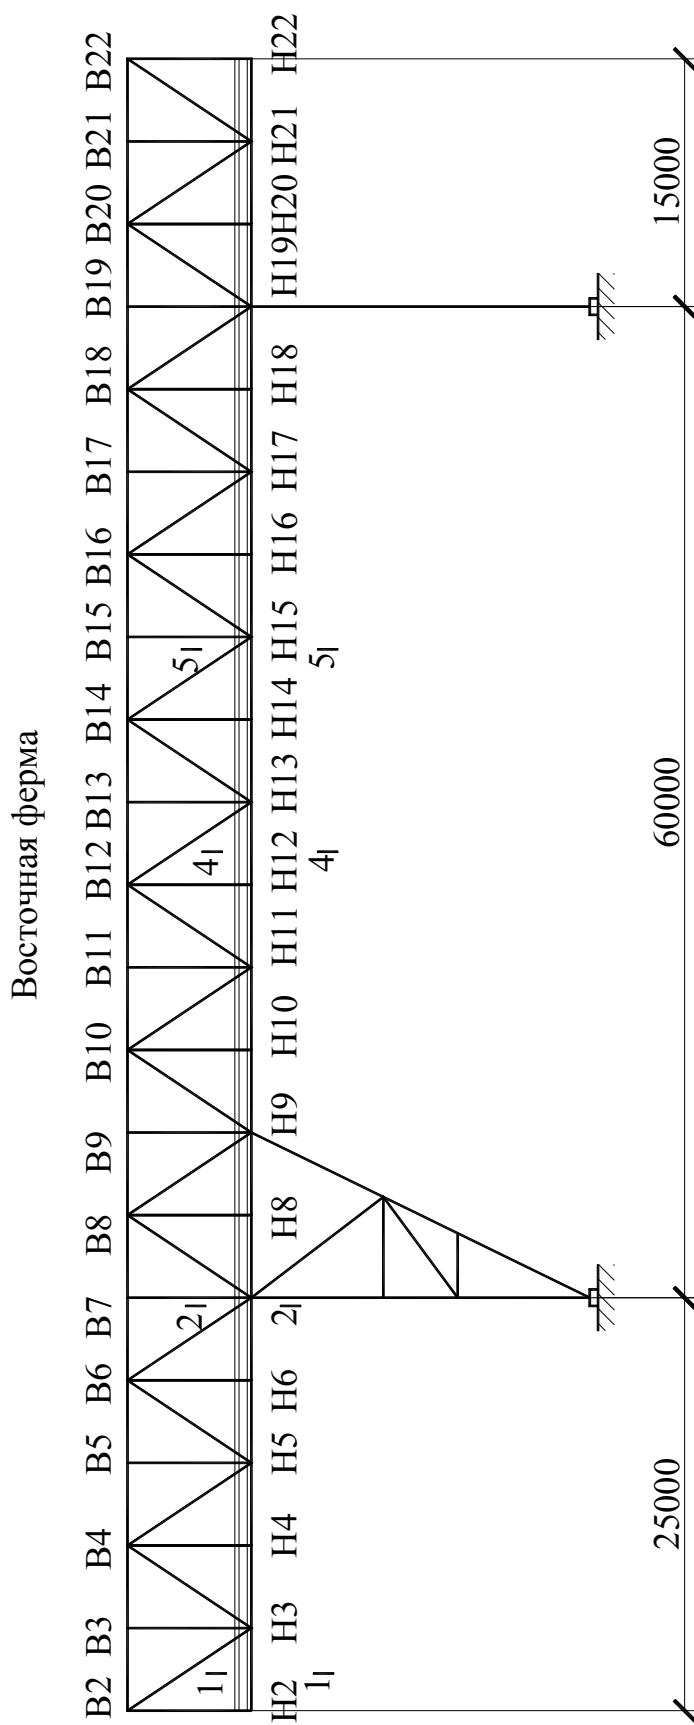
Кран-перегрузжатель Петропавловской ТЭЦ-2
